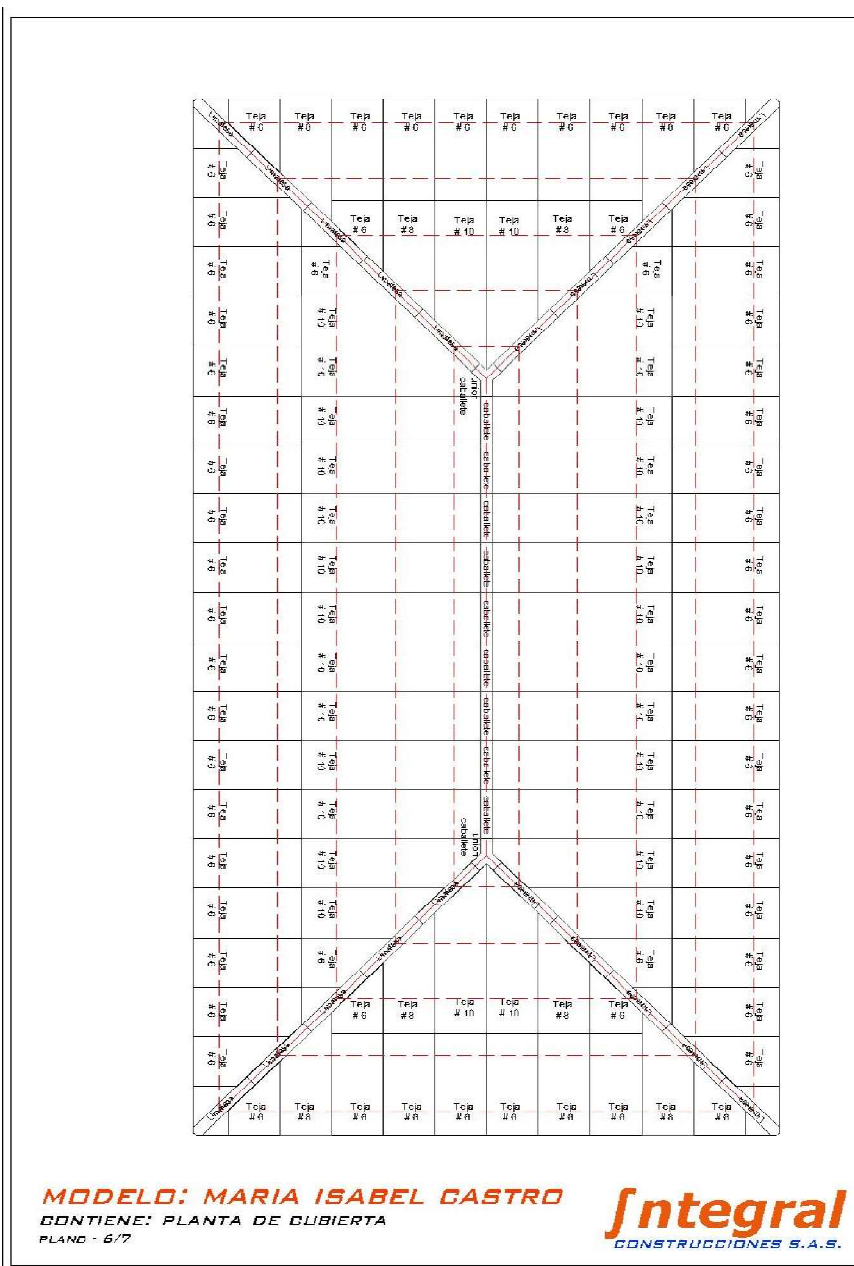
Planta estructura de cubierta vivienda María Isabel Castro
